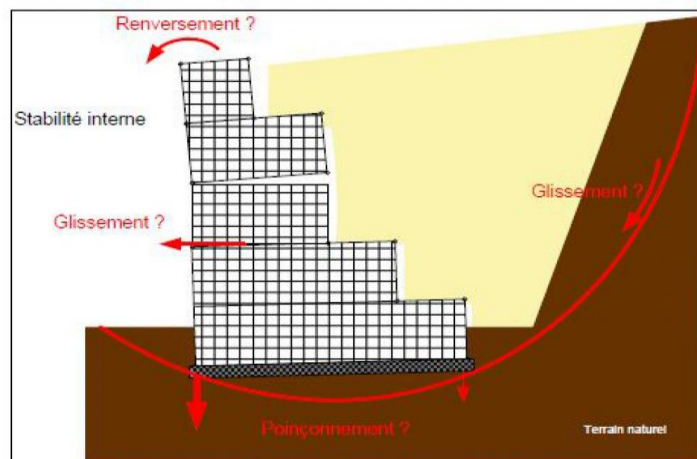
les phénomènes d'instabilité d'un mur de soutènement
